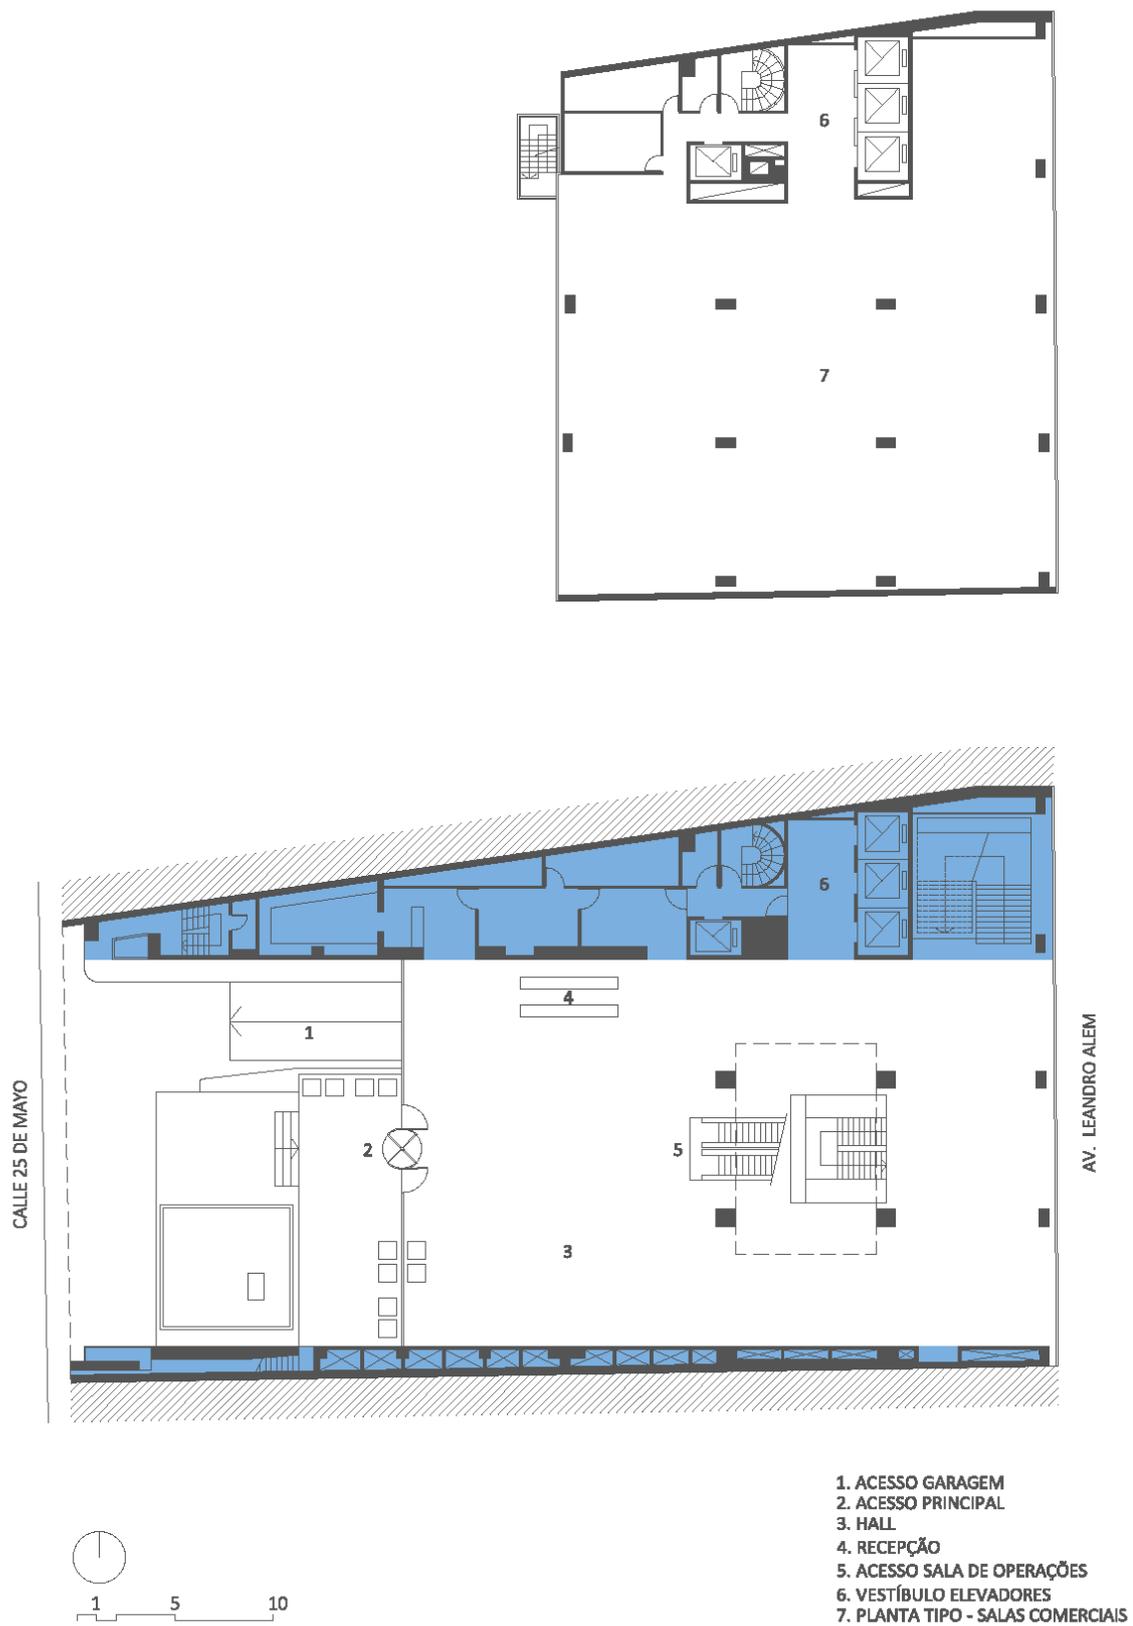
Planta Tipo e Planta térrea ao nível da Av. 25 de Mayo, Bolsa de Comércio de Buenos Aires, 1972-1977.
